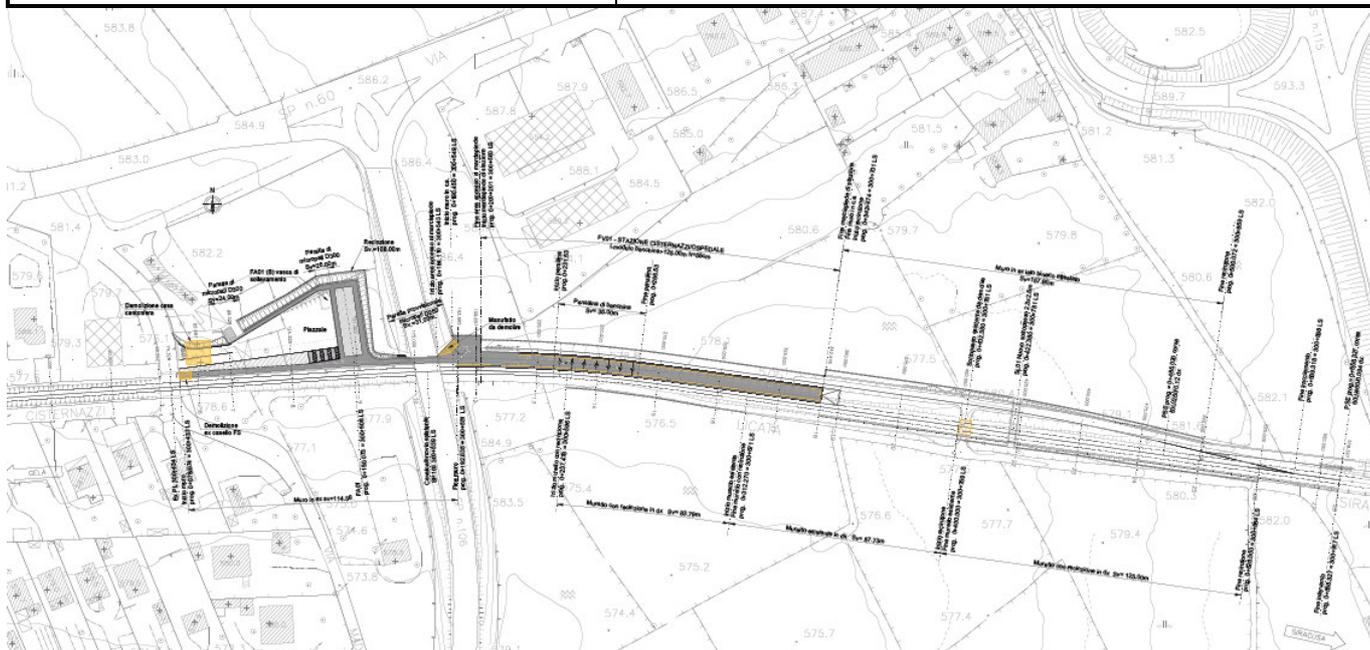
Planimetria di progetto nuova stazione Cisternazzi/Ospedale
